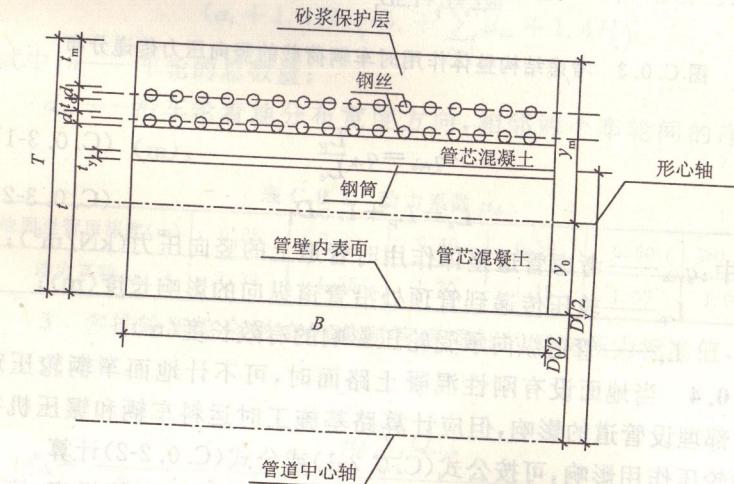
预应力钢筒混凝土管管壁截面示意图
